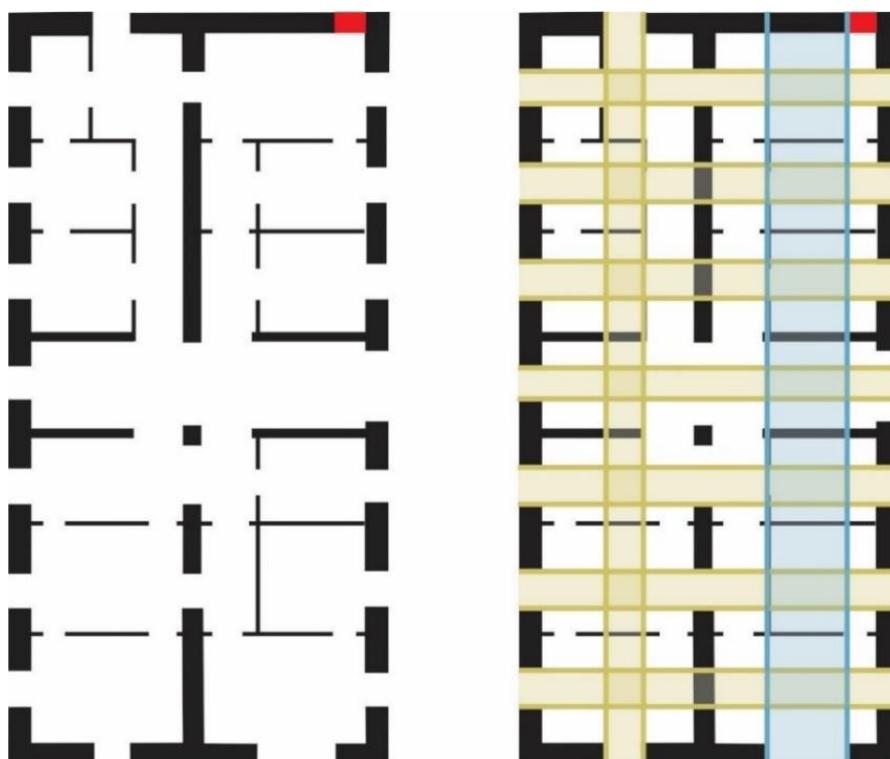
Planta baixa do 1º pavimento do Bloco II do PSC em 1864. Em amarelo as simetrias entre as sacadas e, em azul, das portas. O vermelho foi utilizado a fim de tapar o vão existente na planta.
